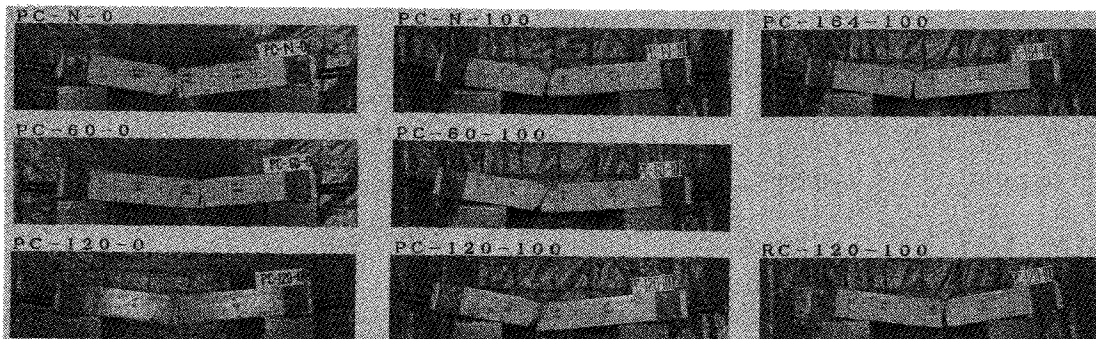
PC 部材曲げ破壊試験の各試験体の破壊状況
